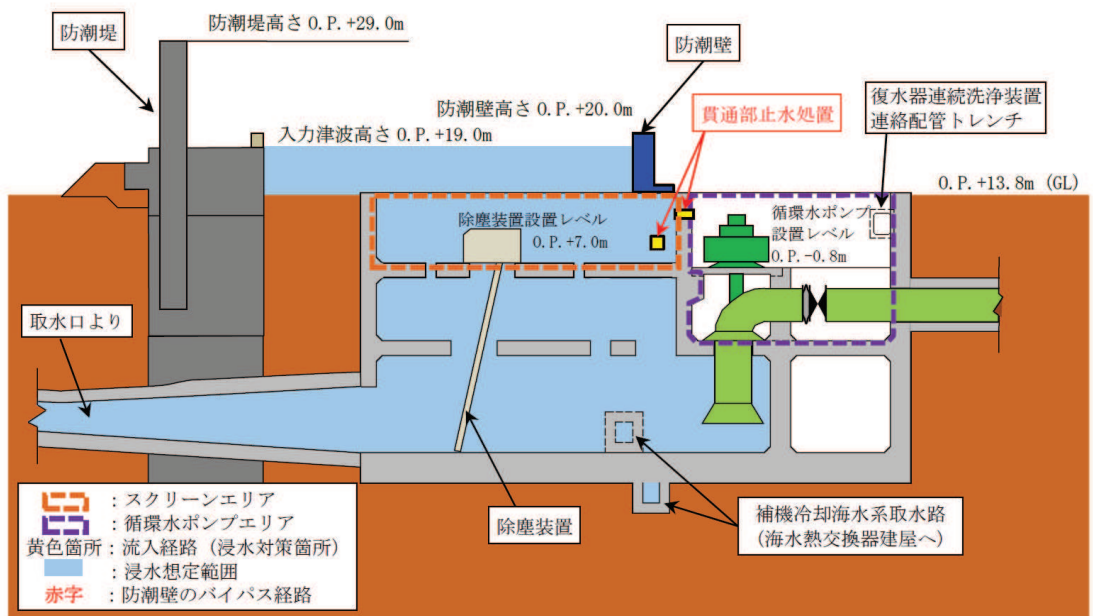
(7) 第 3 号機 海水ポンプ室 流入対策配置図 (A-A 断面図)
